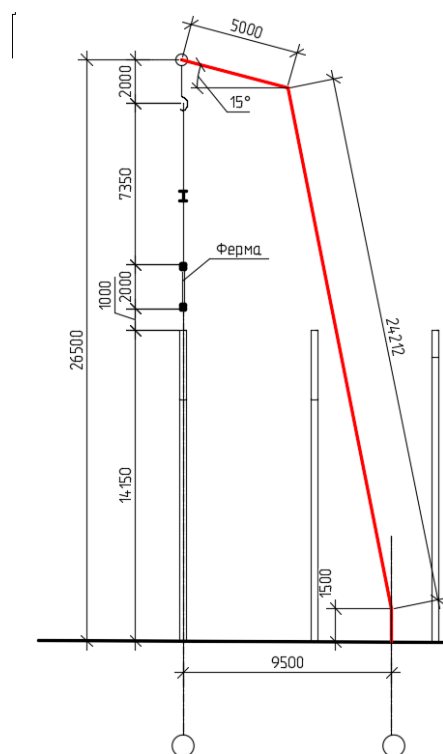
«Графическое определение длины стрелы для монтажа панели покрытия и стропильной фермы» [9]
